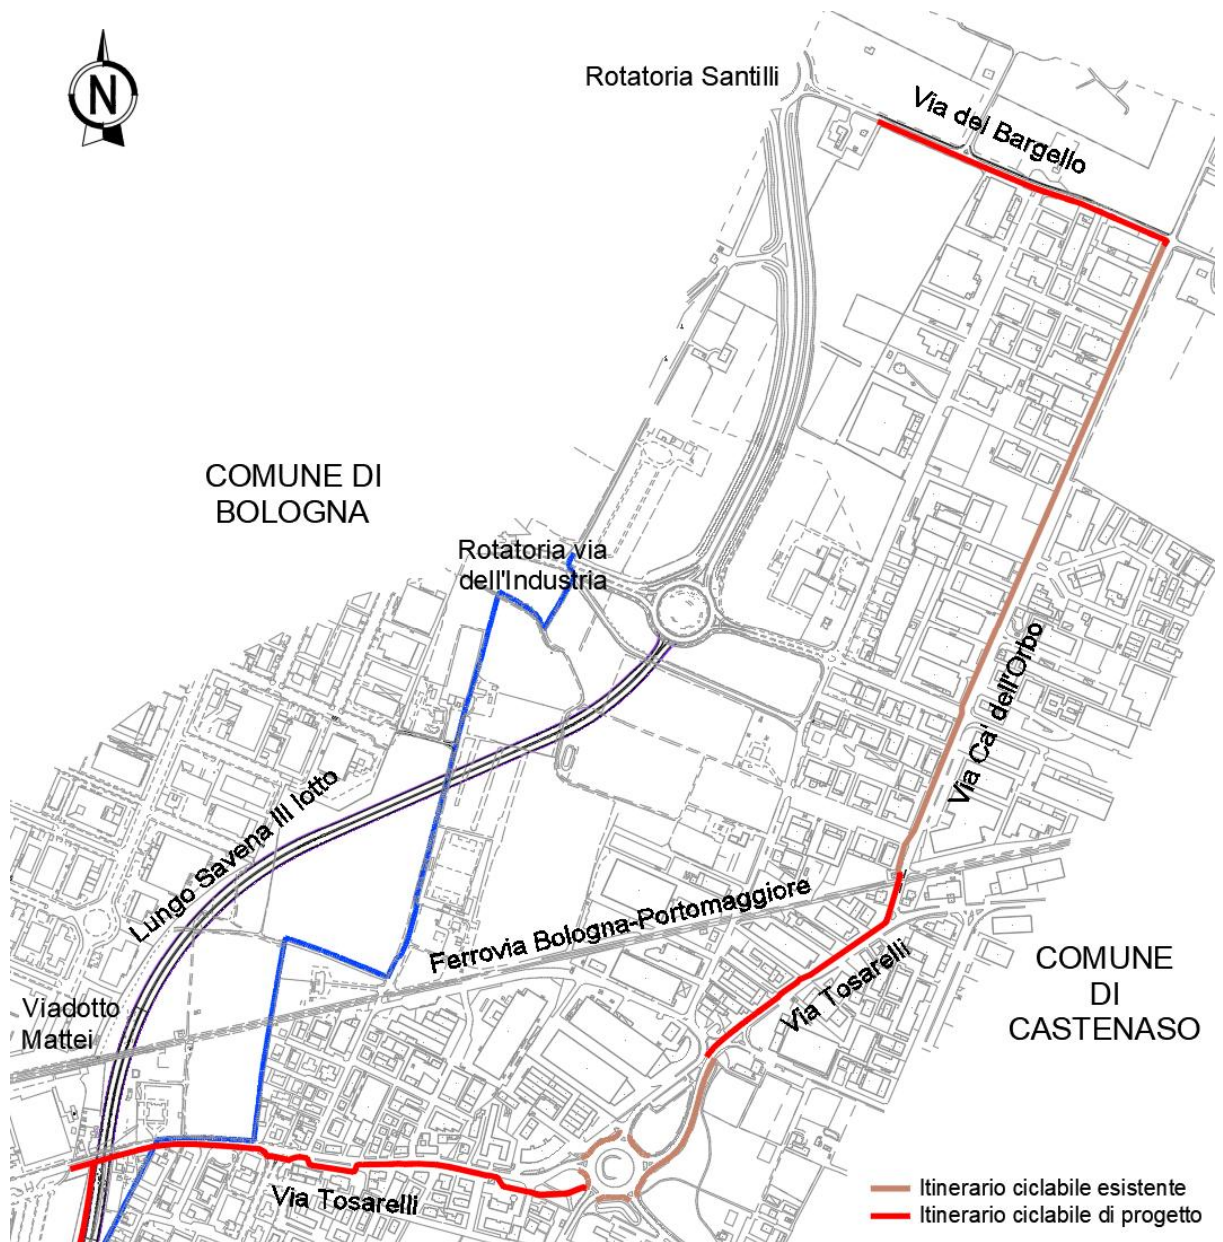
Planimetria schematica dell'itinerario ciclabile.
